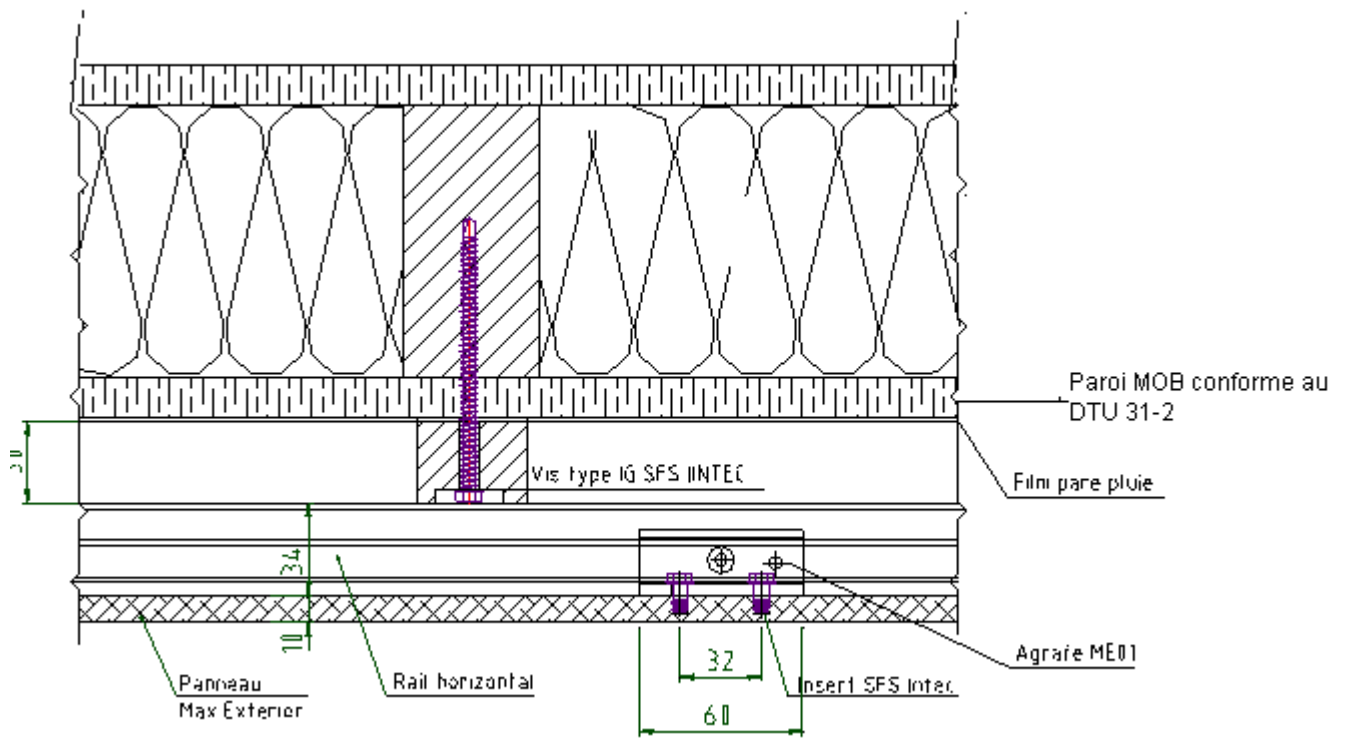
Coupe horizontale – Pose sur MOB- Détail fixation du tasseau sur montant MOB
